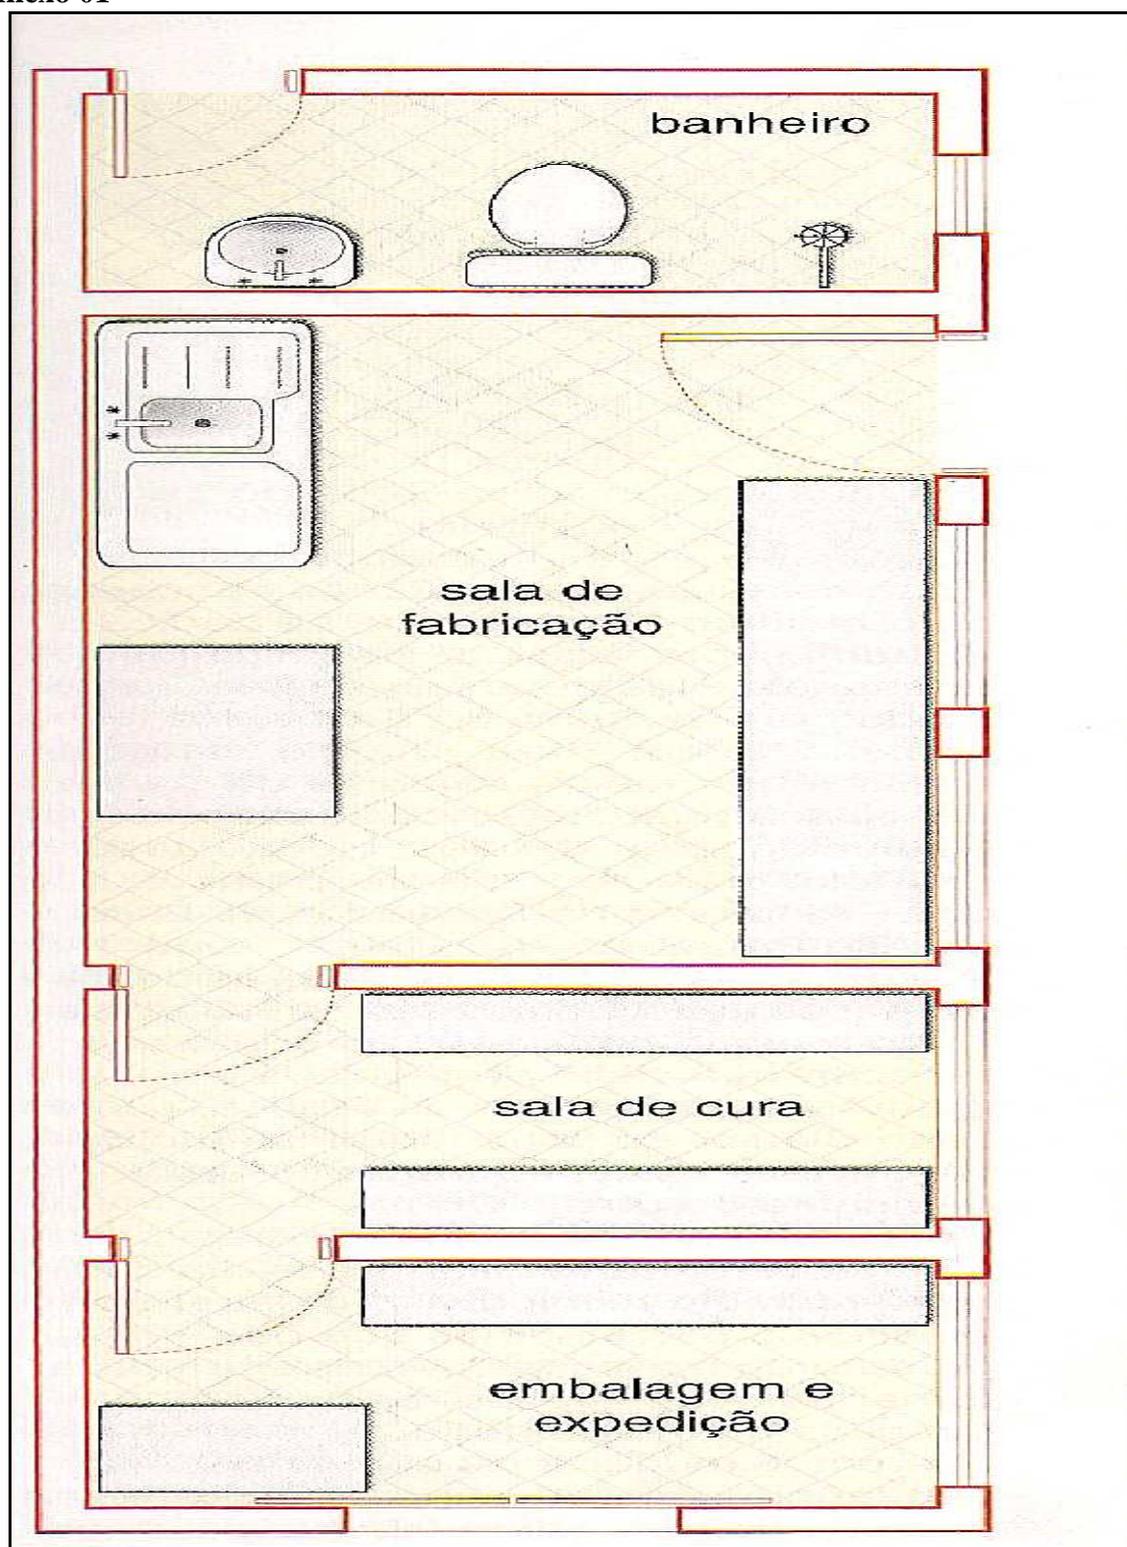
Planta baixa de queijaria artesanal – Minas Gerais.
